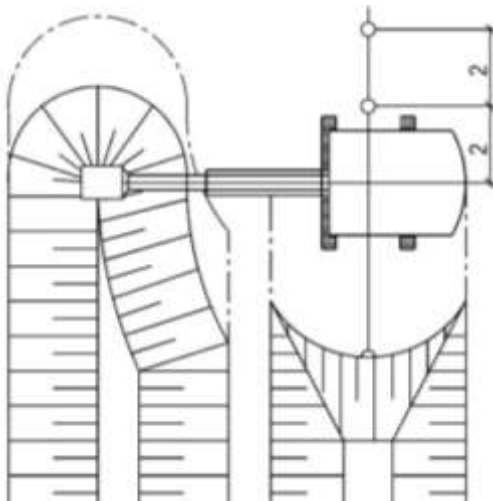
Продольная схема разработки выемки ЭО, с рабочим оборудованием обратная лопата
